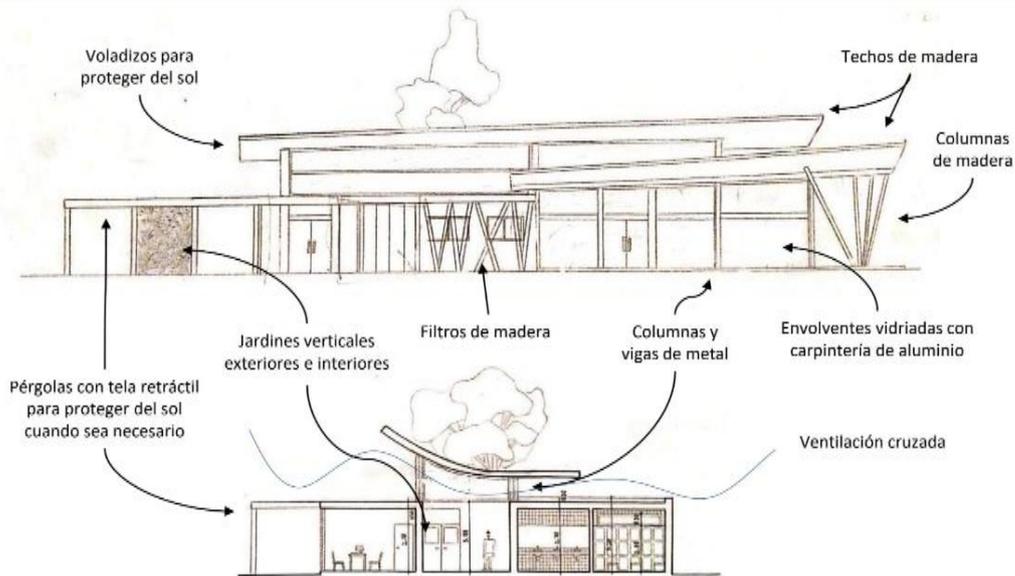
Fachada y corte que expresan en detalle la materialidad empleada
